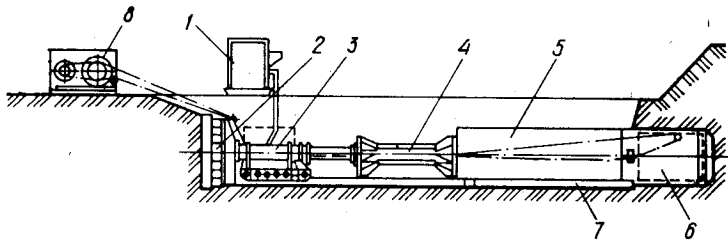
Установка для бестраншейной прокладки труб У-12/60:
